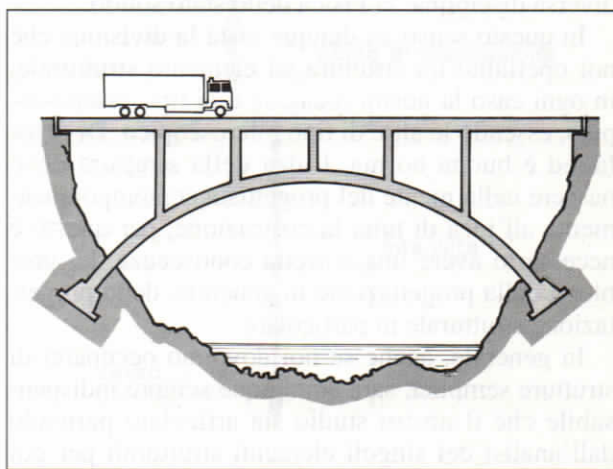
Esempio di sistema strutturale complesso: ponte ad arco a via superiore.
